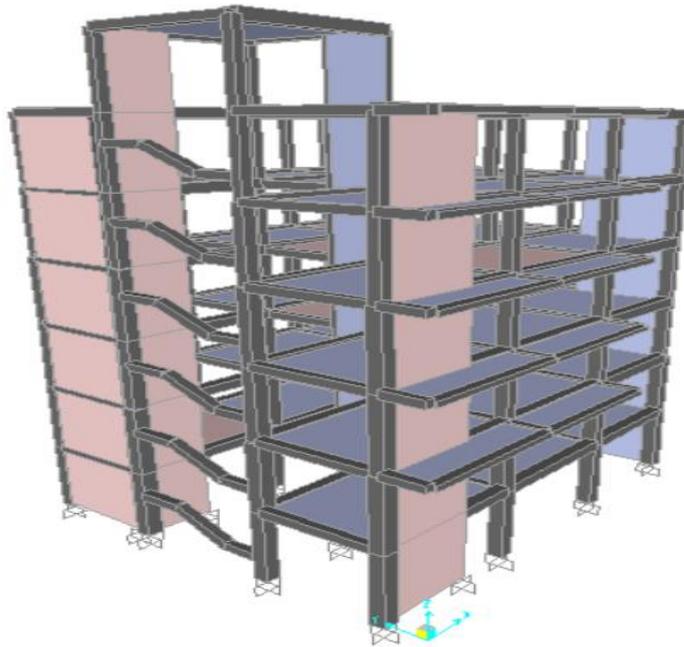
Illustration 3D du bâtiment de référence construit en béton
